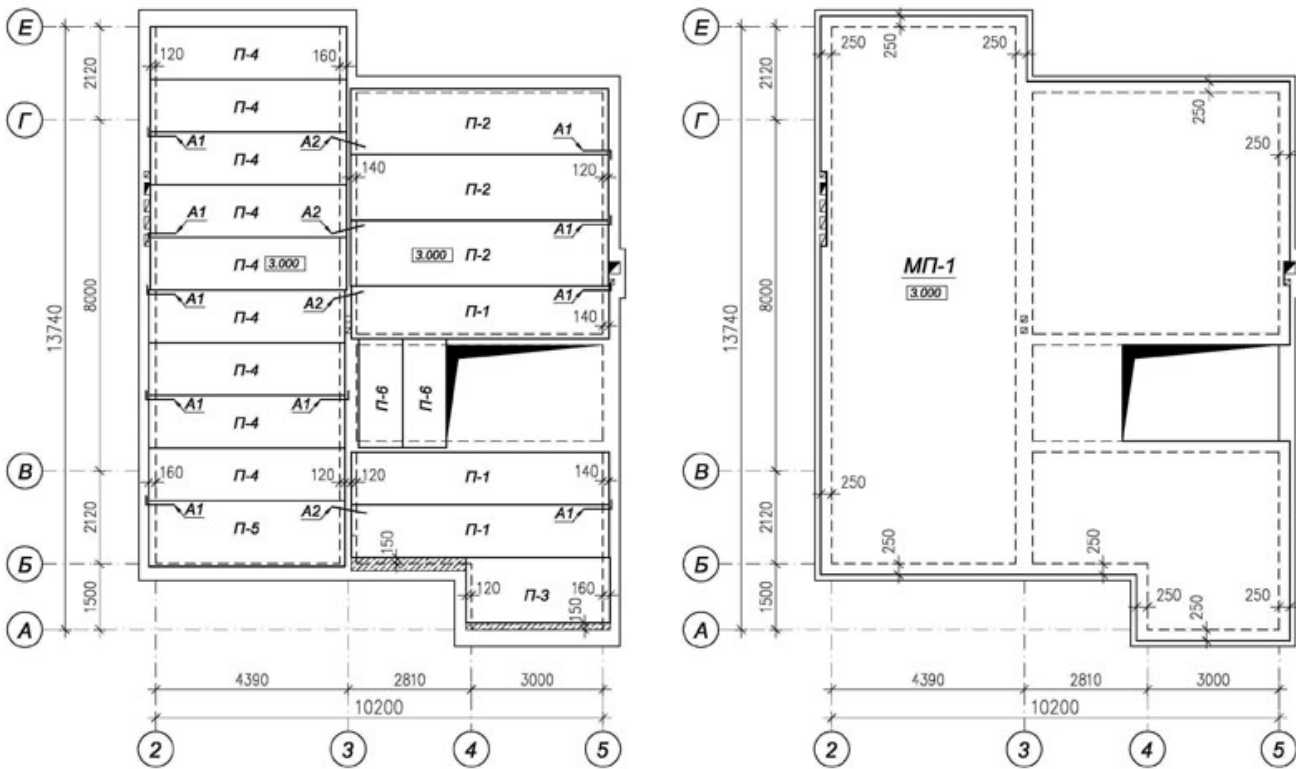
,16. Пример оформления чертежей планов перекрытий (плитами перекрытий, монолитные перекрытия)
